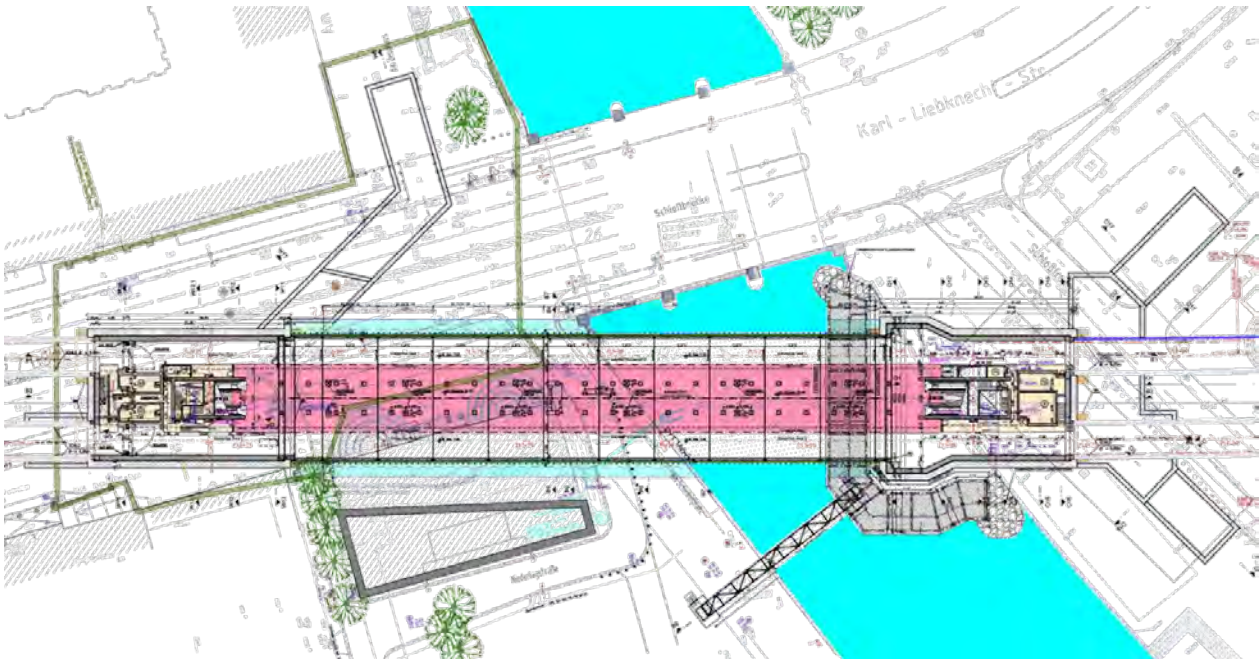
Grundriss Station Museumsinsel, Schacht West und Ost [3]
